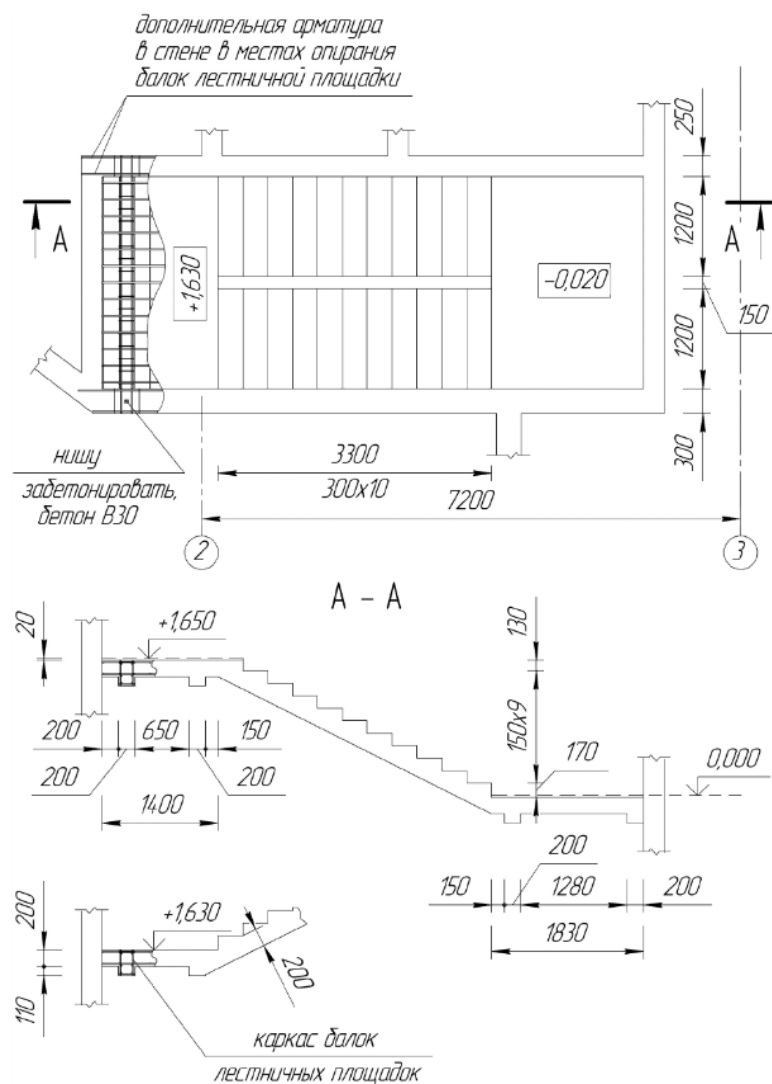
Схема армирования узлов сопряжения монолитных лестниц и междуколонных балок
